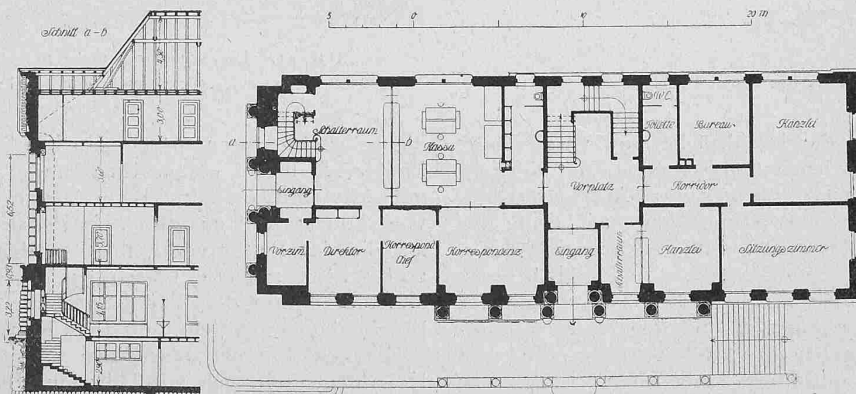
Schnitt a-b und Abb. 3 Erdgeschoss-Grundriss. — Masstab 1:400.
